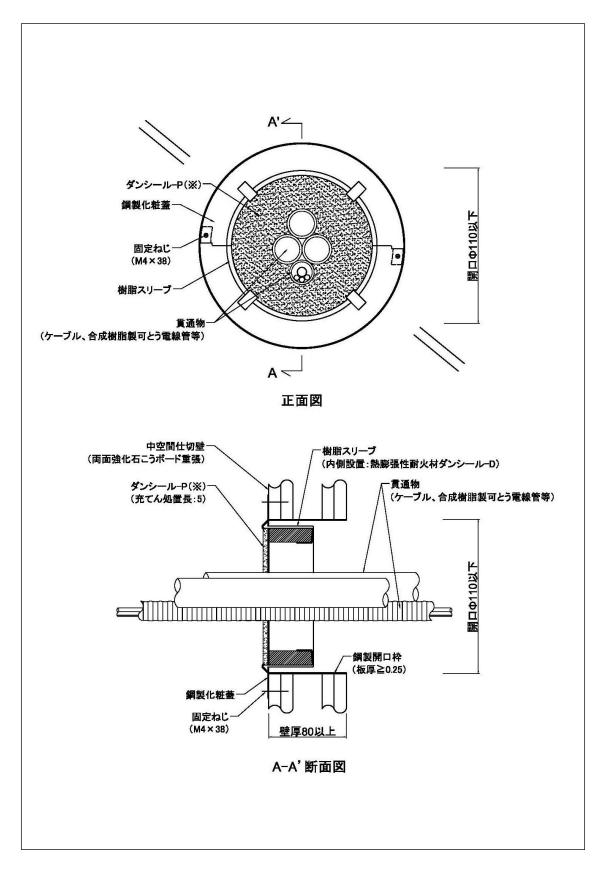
プチロクワイド 標準施工図(中空壁 片側施工)
